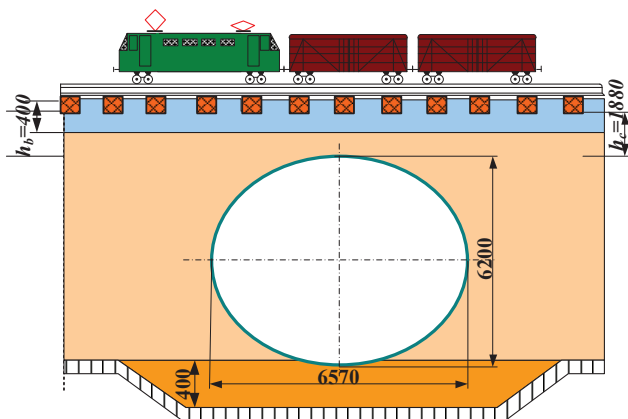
Розрахункова схема до розрахунку міцності металевих гофрованих конструкцій поперечного перерізу типу горизонтальний еліпс
